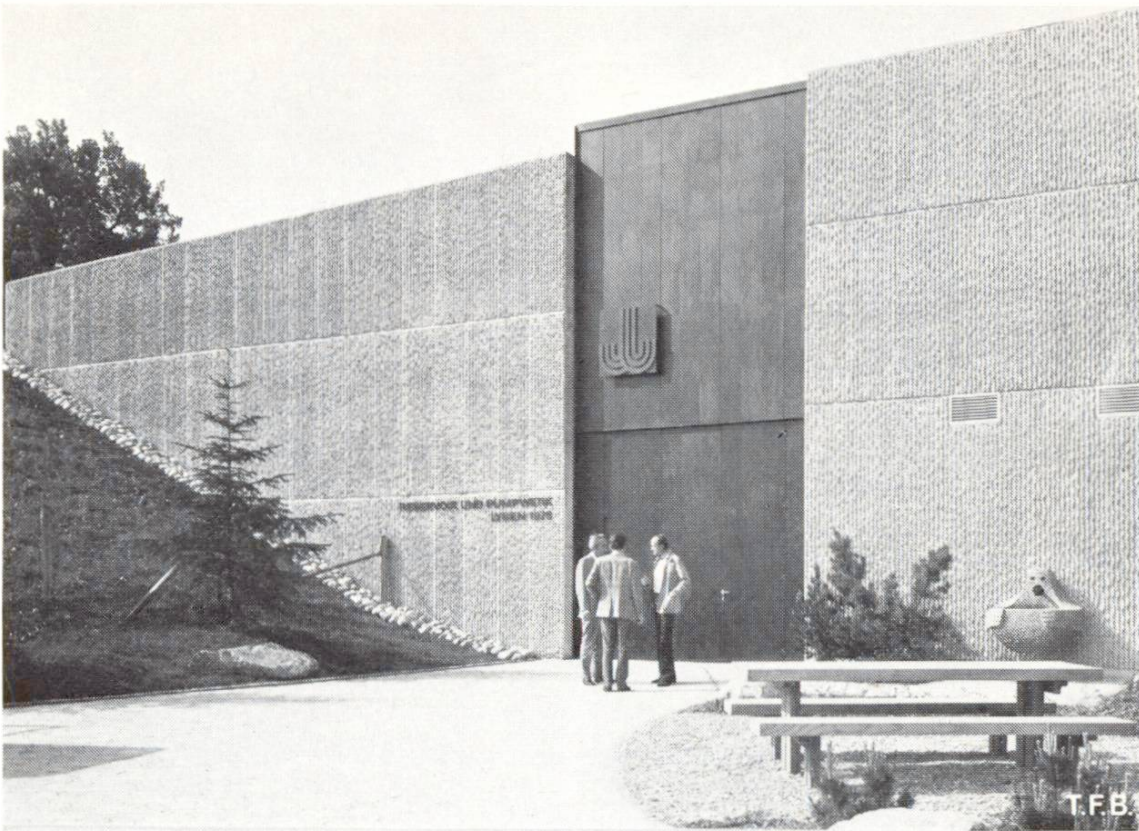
Künstlerisch gestaltete Frontseite mit gerippter Betonoberfläche (Ortsbetonausführung).
